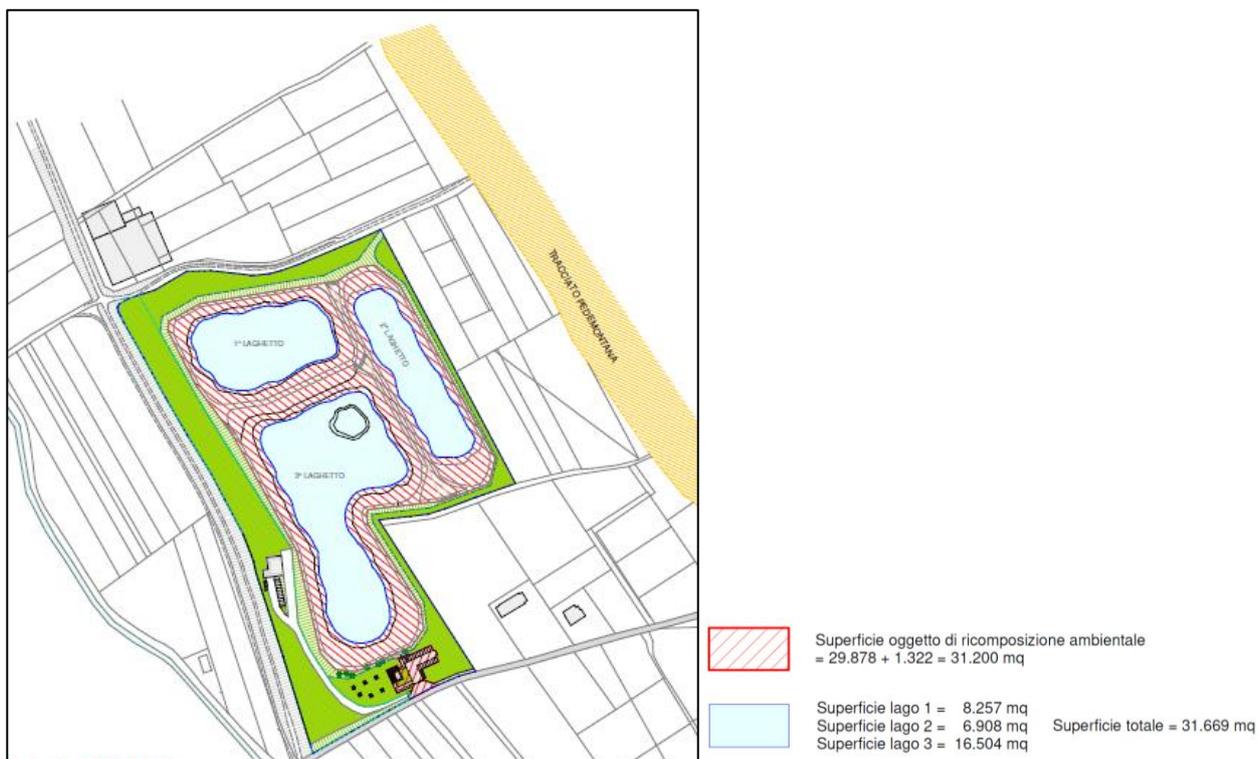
Estratto planimetria con indicazione della superficie oggetto di riduzione superficie boscata
